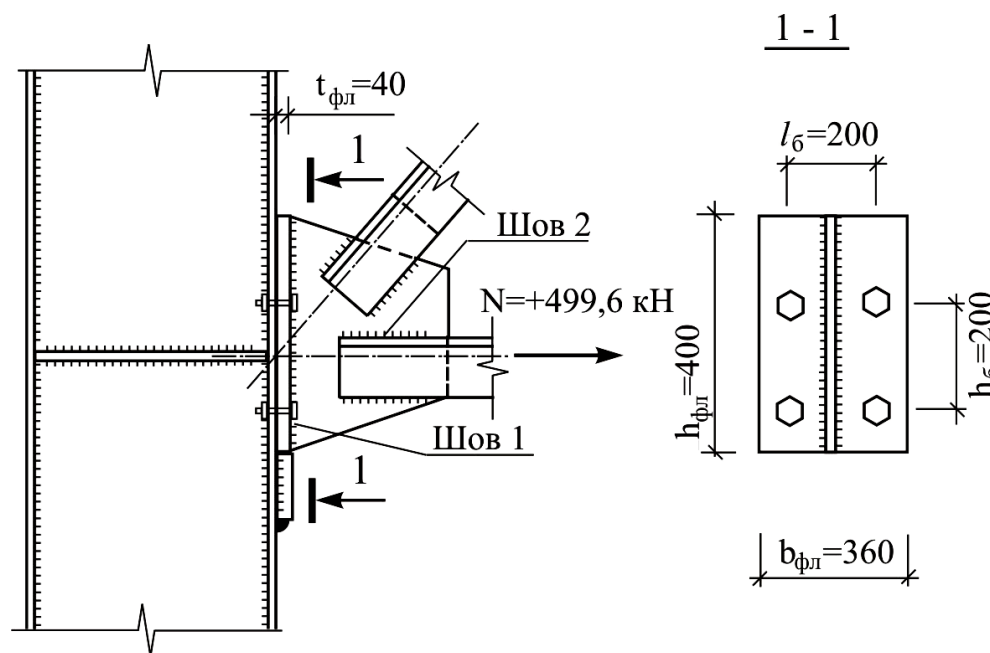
Узел примыкания верхнего пояса фермы к колонне
